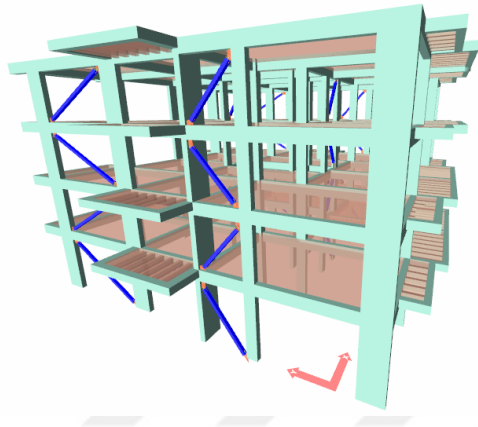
Betonarme Perdelerin Kaldırılıp Çerçeve Taşıyıcı Sistemli Oluşturulan Modelin Kalıp Planı
